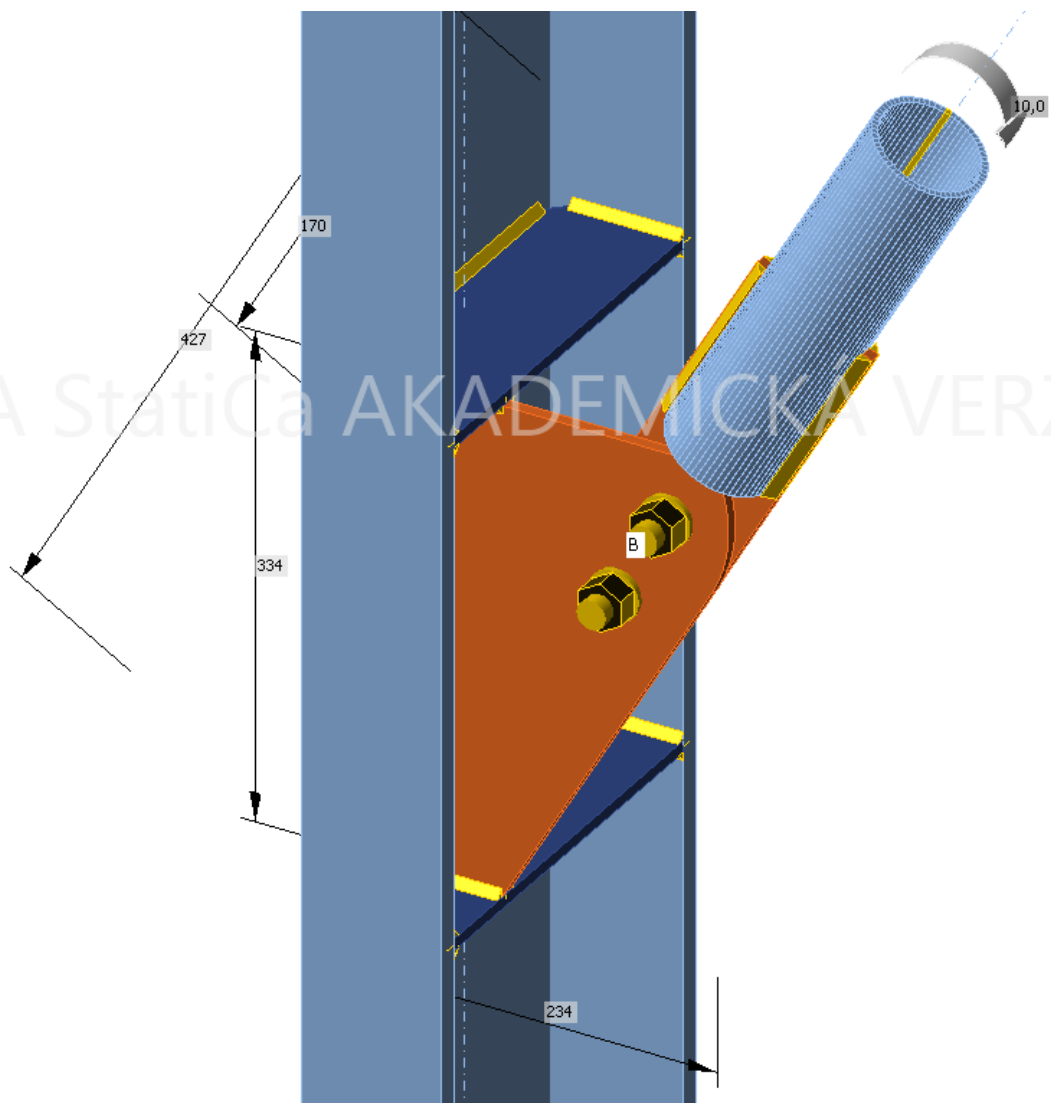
Geometrie přípojovacího plechu styčníku 2
